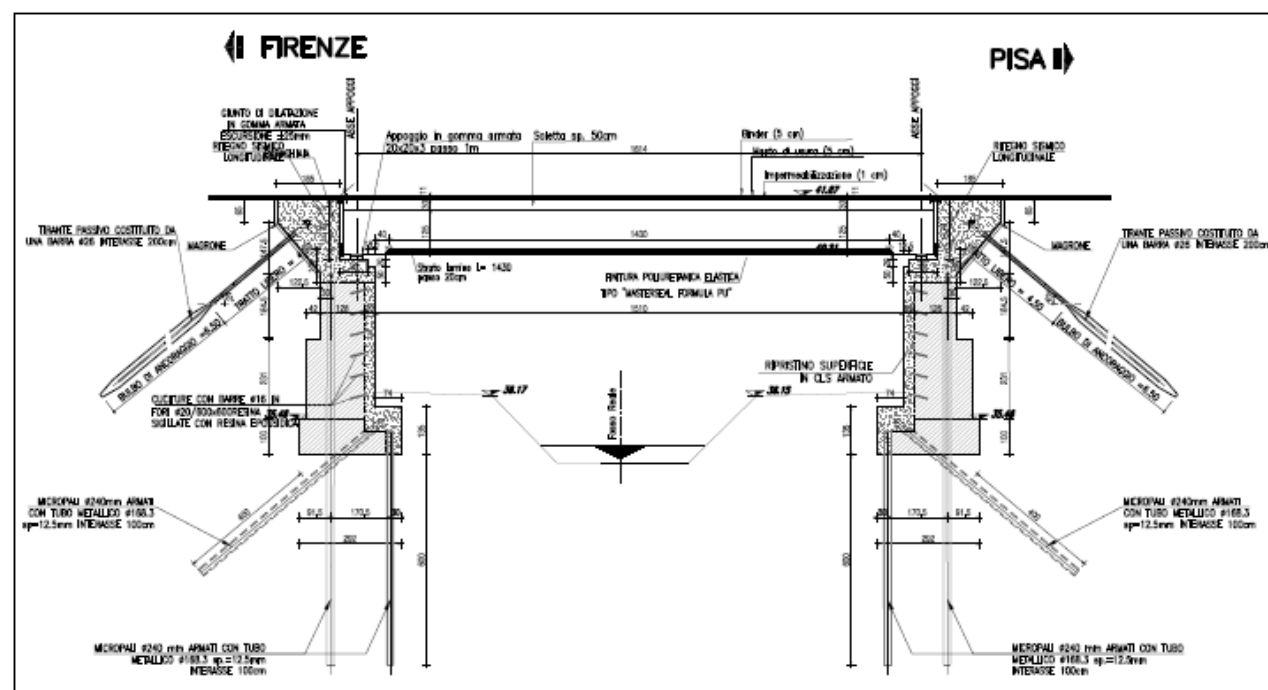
Ponte sul F. Reale. Sezione longitudinale
